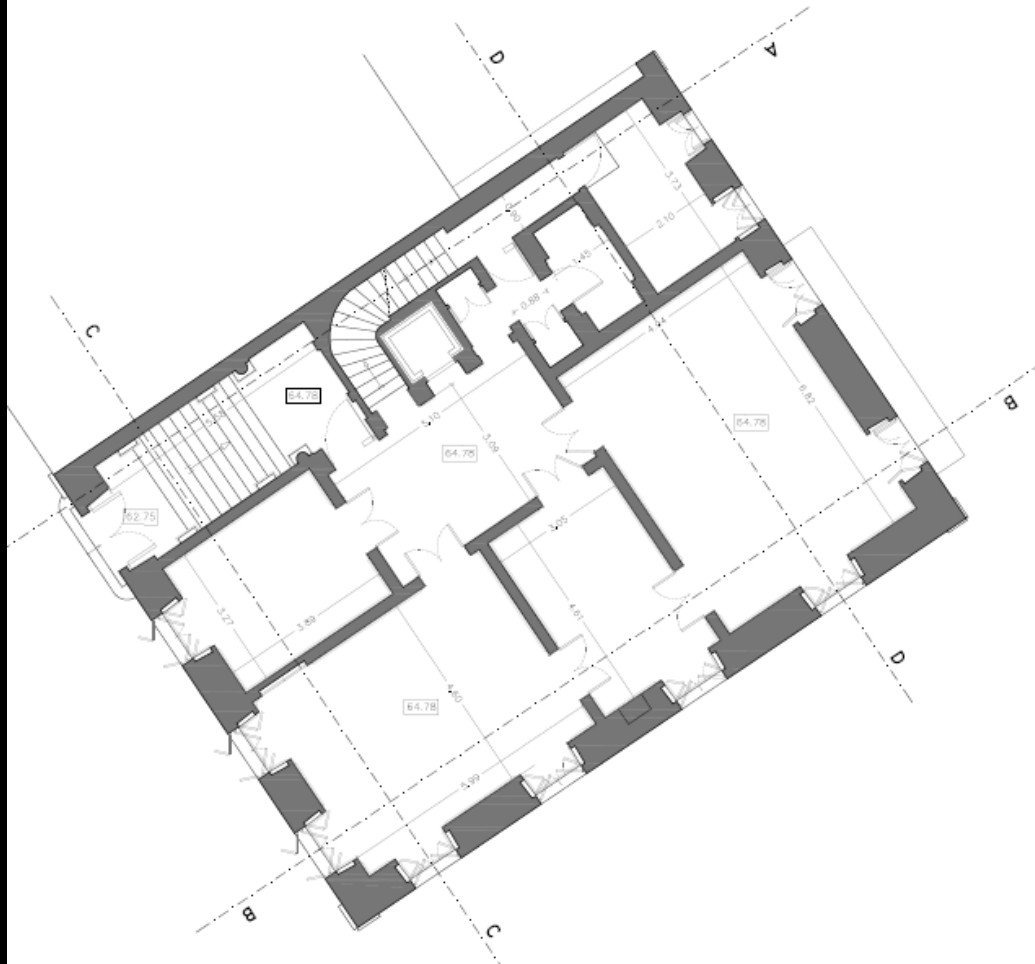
Planta do piso -1 e rés-do-chão [1].
